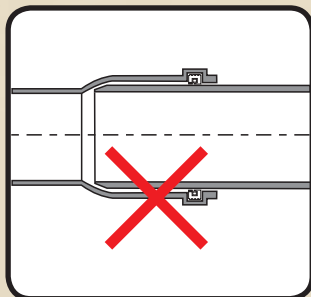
Shema betonirane cijevi s prekrivenim spojem
